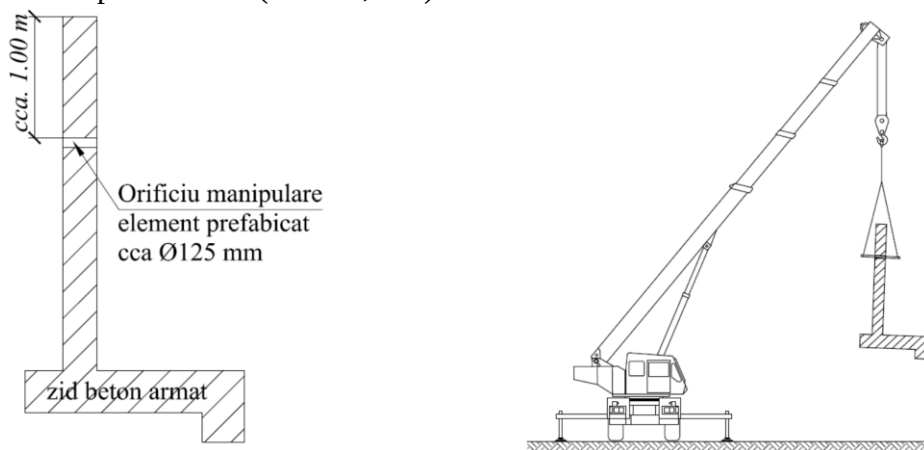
Manipularea și pozarea elementelor prefabricate de zid de sprijin de beton armat
